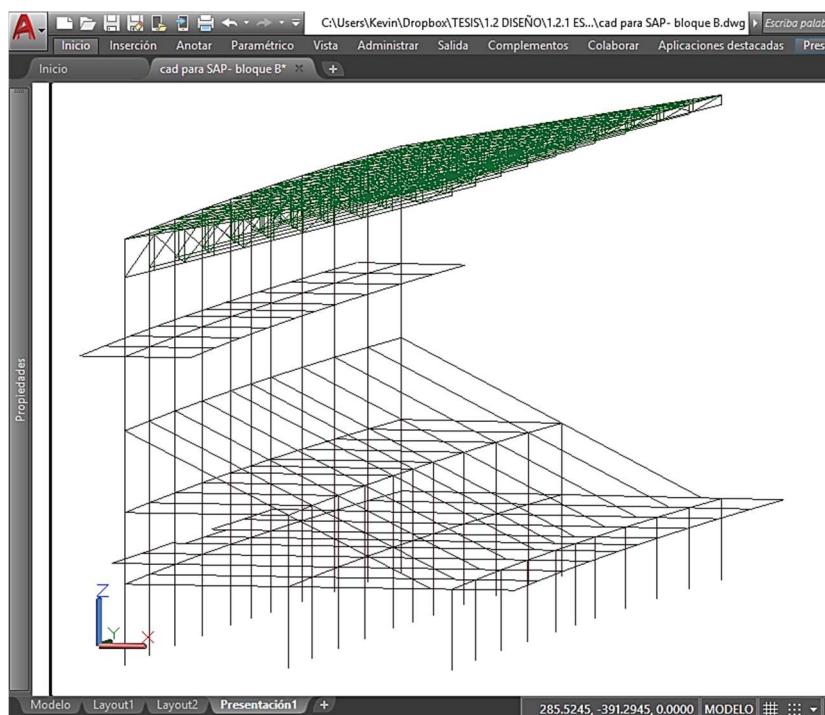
Dibujo en 3D en autocad del Bloque B
